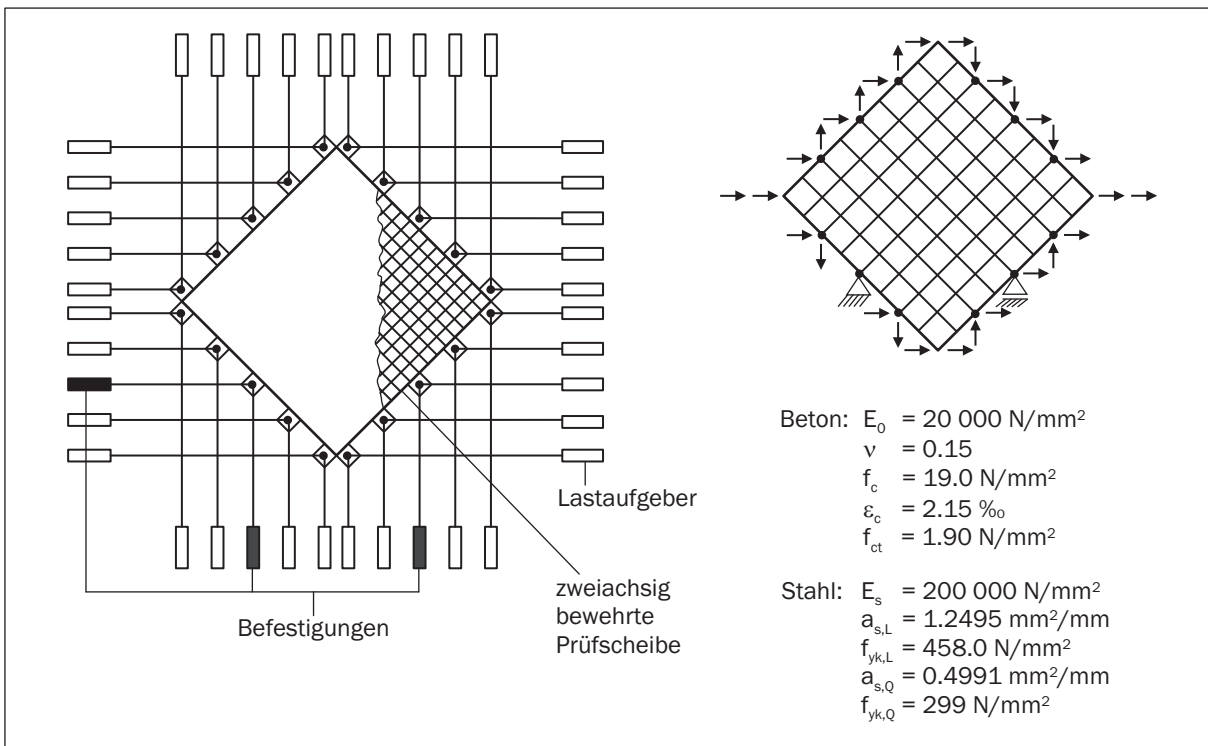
Versuchsaufbau und Materialdaten einer Stahlbetonscheibe unter Schubbeanspruchung nach Vecchio & Collins (1986)
